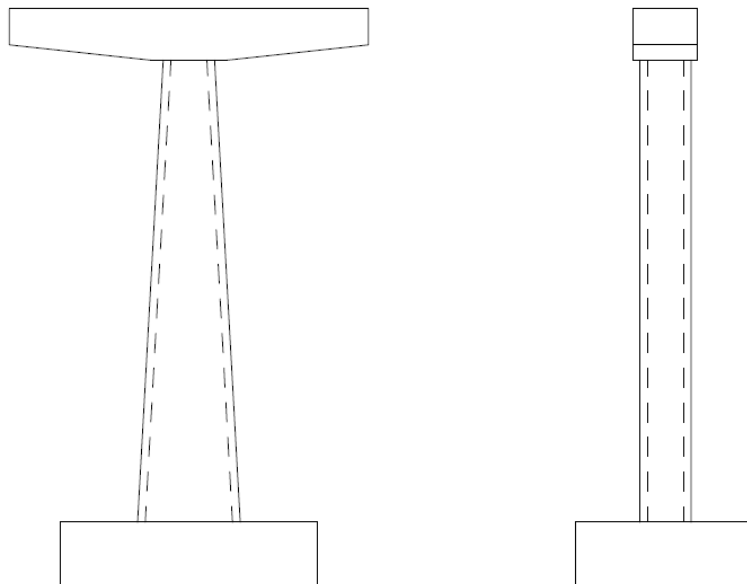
Alzado (izquierda) y perfil (derecha) de la pila dimensionada
